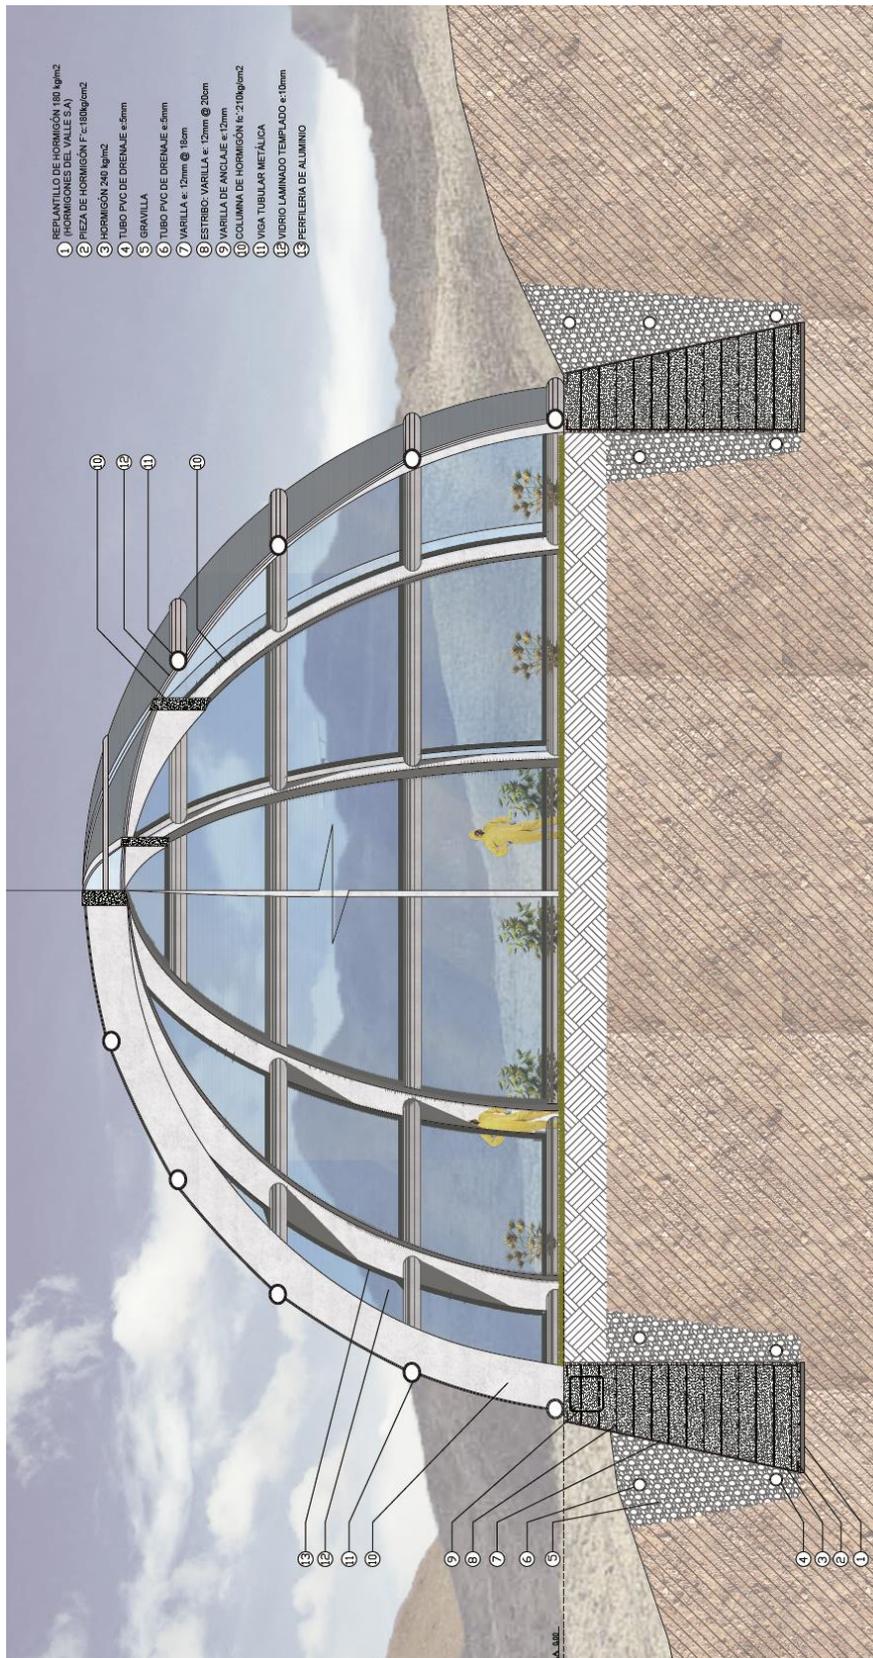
Detalle Constructivo 2 (fuente: elaboración propia)
